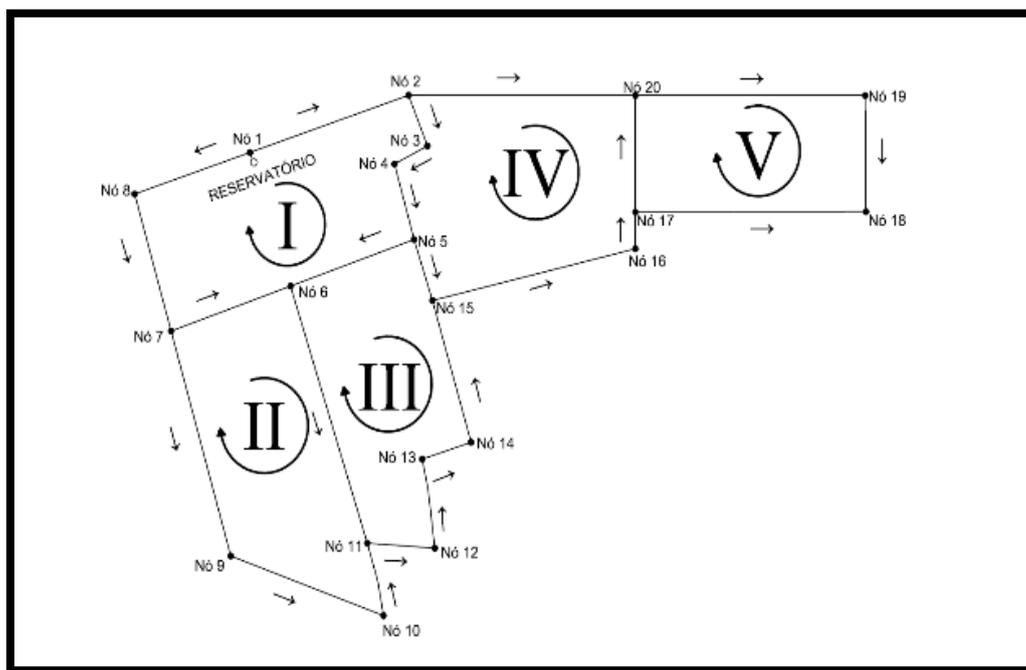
Rede malhada proposta para o sistema de abastecimento do bairro do Pantanal
